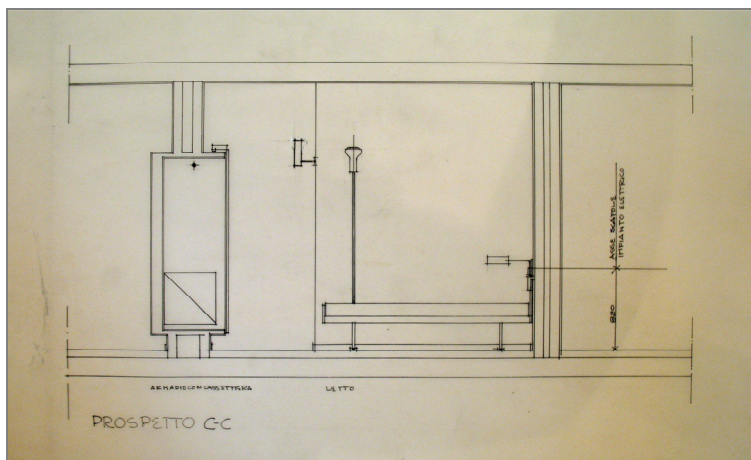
camera tipo, prospetto CC (fonte CSAC – stralcio tav. 33, archivio n. 276-1)
